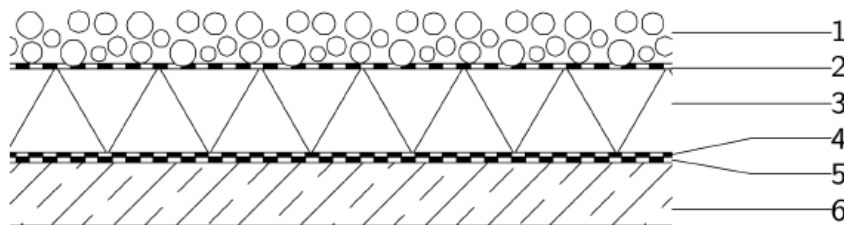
Dachaufbau D02 Umkehrdach mit Kies
